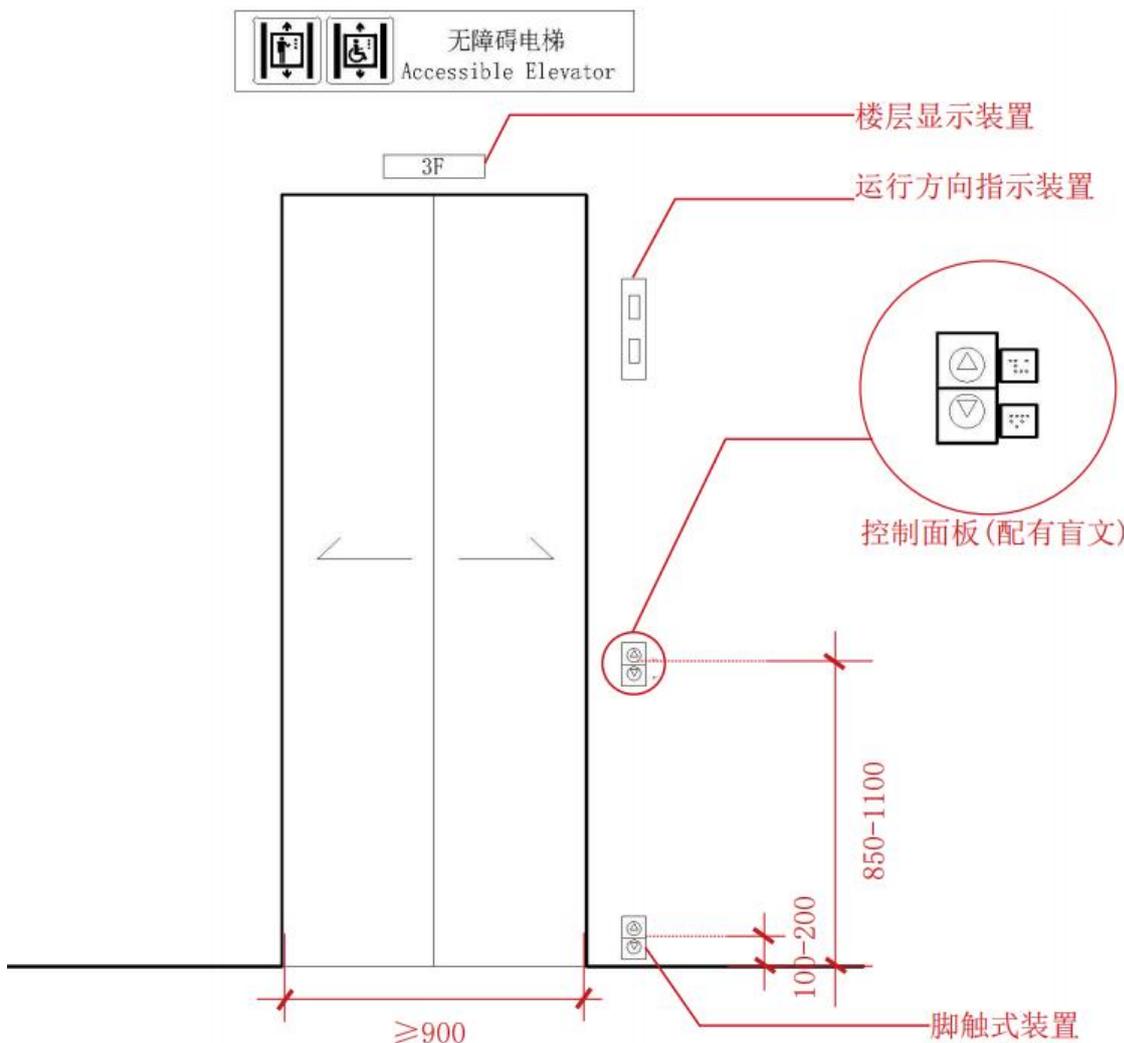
轿厢外部配置示意图（单位：mm）
